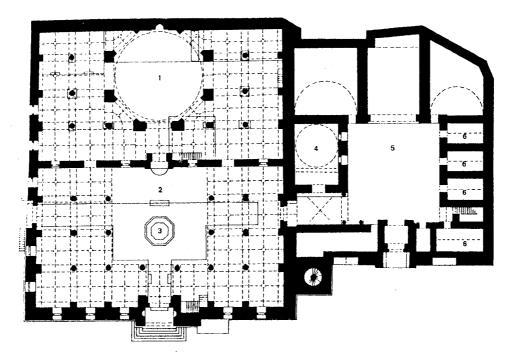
مسقط أفقي لمسجد علاء الدين في قونيه . (عن : آصلان آبا) .
